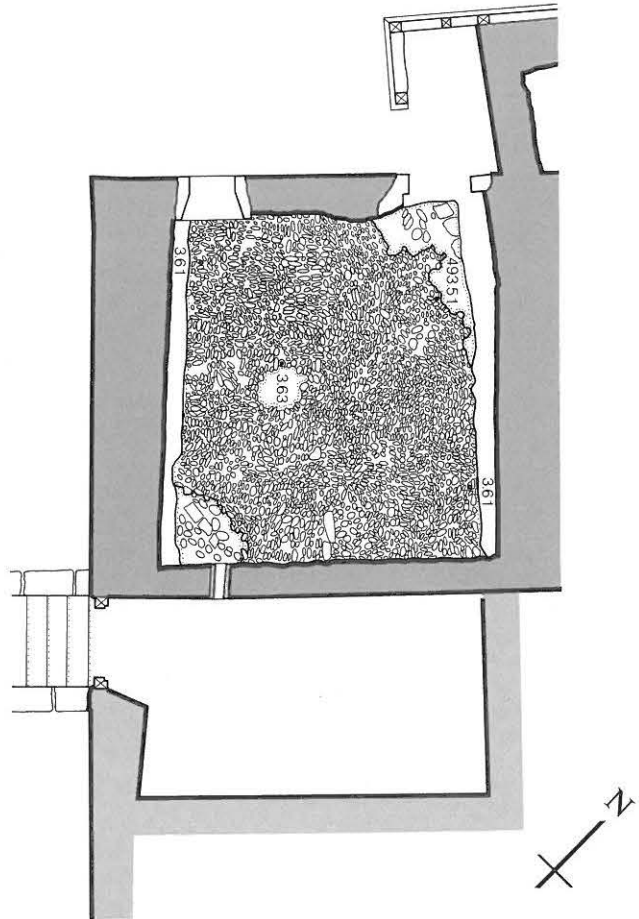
Laupen, Kreuzplatz 1. Kernbau mit Pflästerung. Grundriss Kellergeschoss. M. 1:100.
